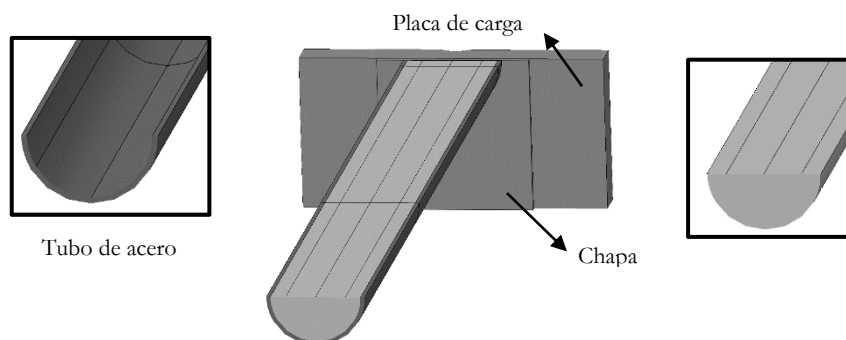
Ensamblaje de las partes del modelo en columna monotubo (CFST).
